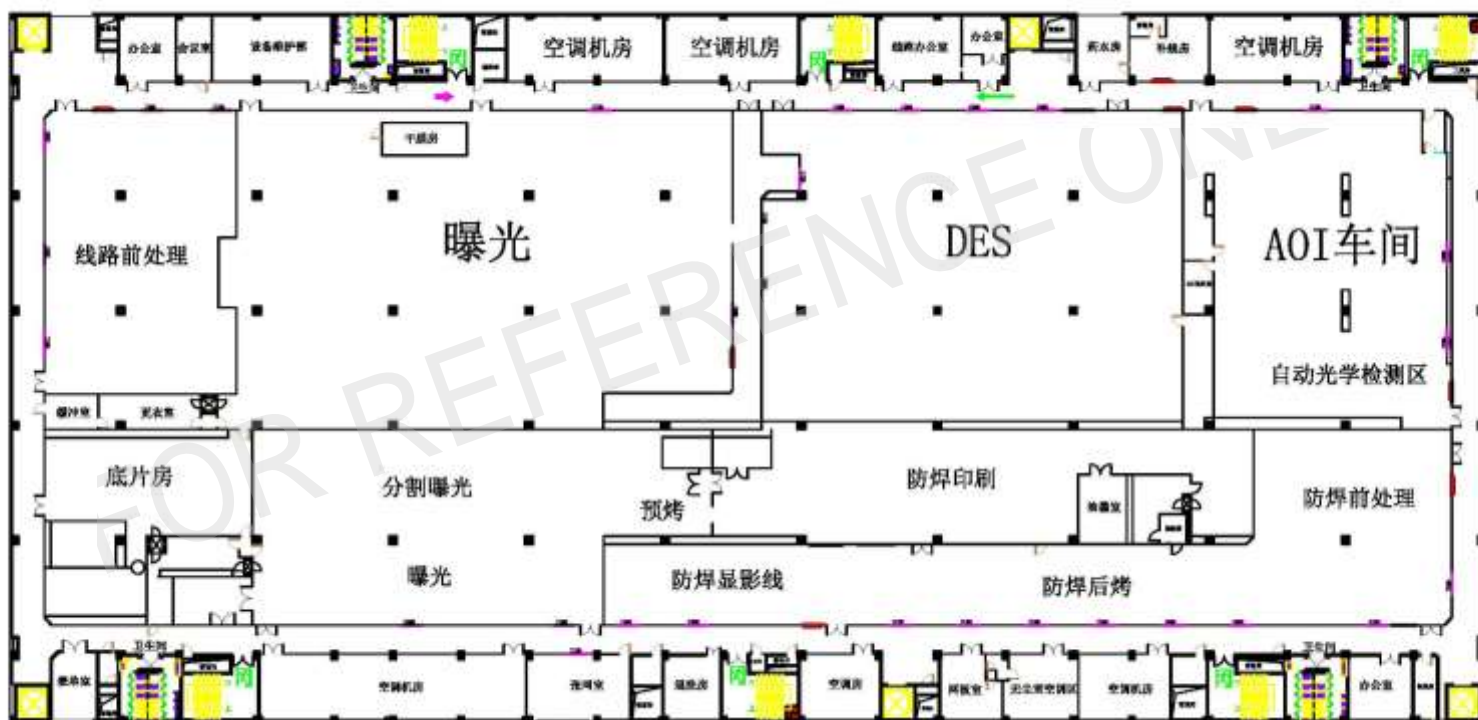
鹏鼎公司 A3 栋厂房三层车间平面布置图
